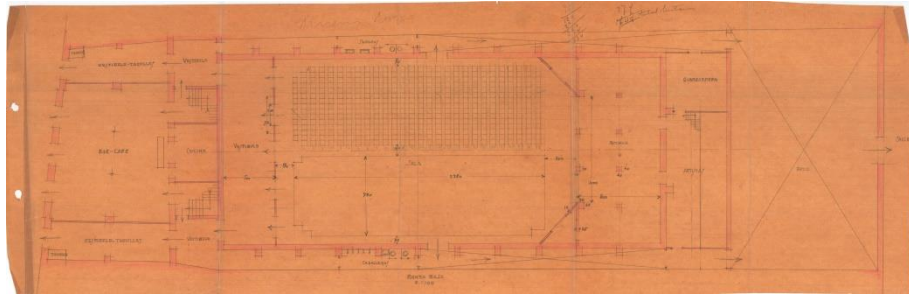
Plano planta baja de la reconstrucción del Teatro Rambal
